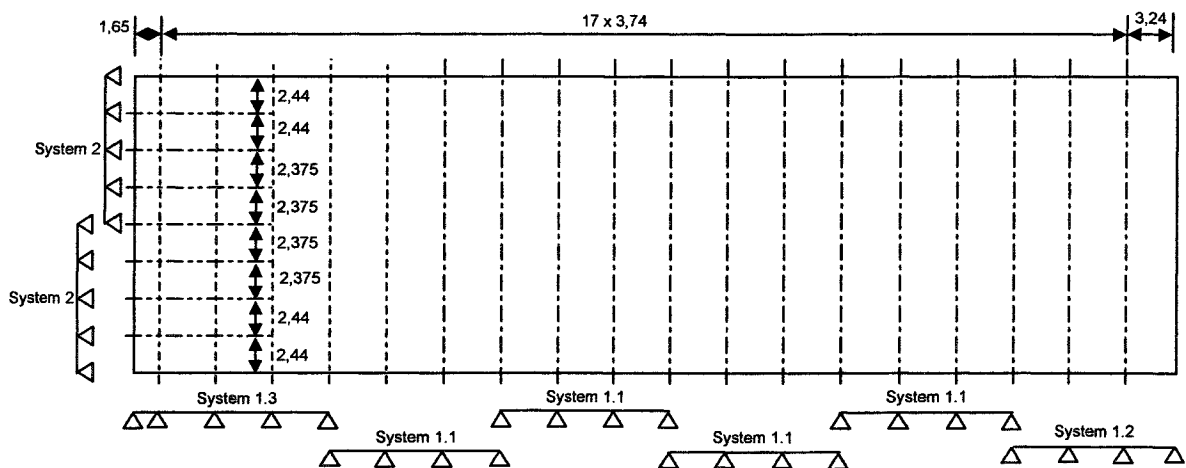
Grundriss mit Sandwichelement-Systemen
